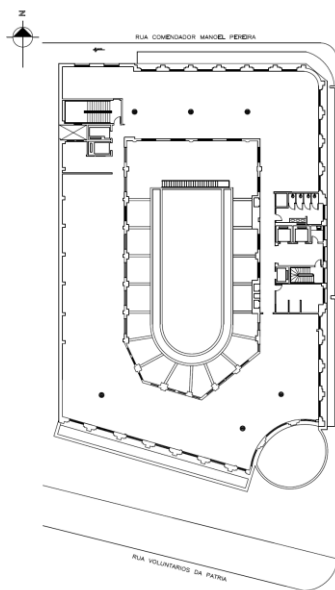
Magazine Mesbla, Porto Alegre(1944). Planta baixa tipo.
